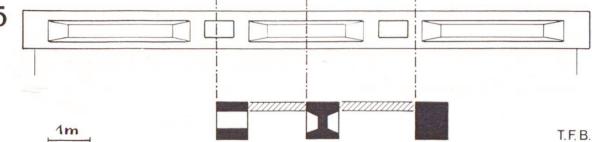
Poutres préfabriquées en béton pour les planchers. Portée 13,8 m, écartement 3,5 m. La section est irrégulière à cause de deux grosses ouvertures destinées au passage des canaux de ventilation.
